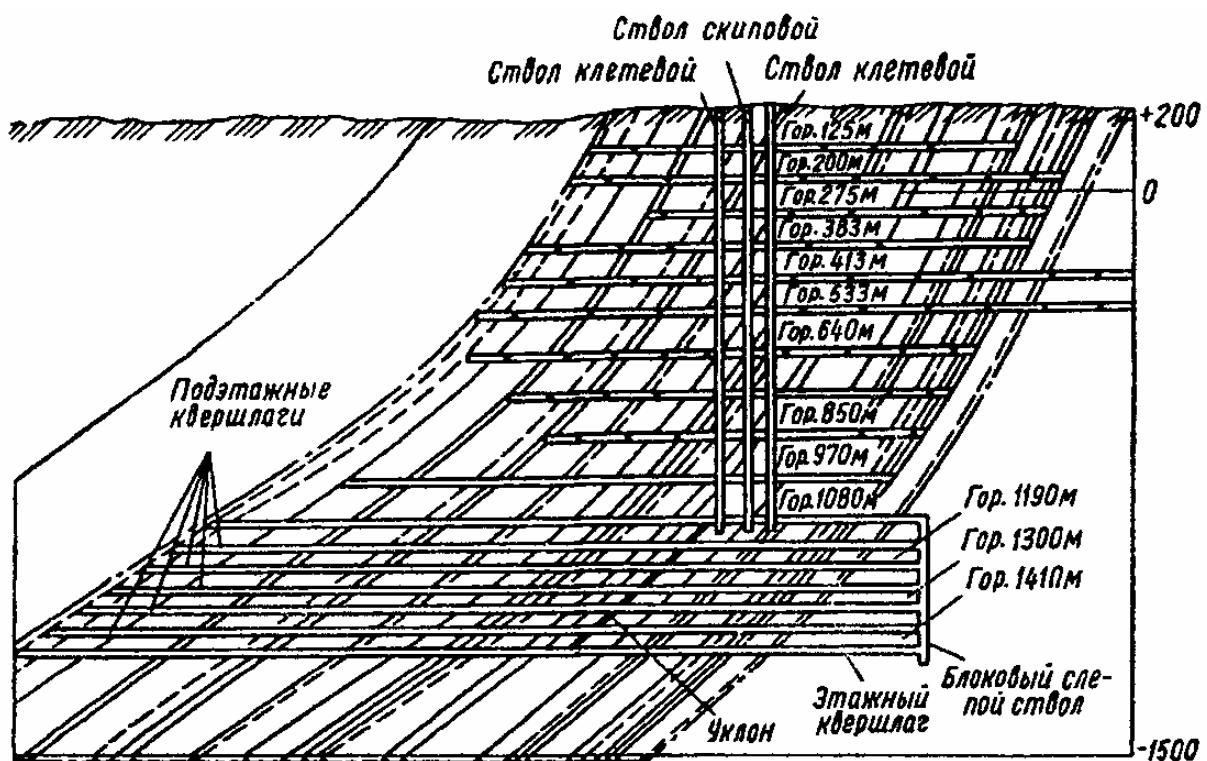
Схема вскрытия круtyx пластов на новых горизонтах вертикальными стволами и уклоном с разделением этажа на подэтажи
